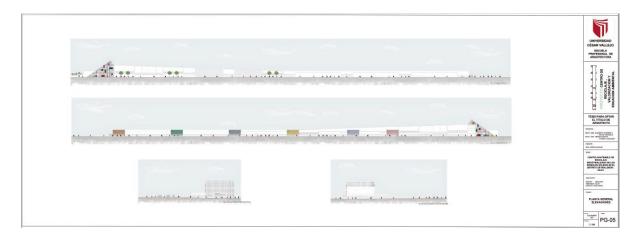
Plano General – Elevaciones FUENTE: Elaboración Propia
